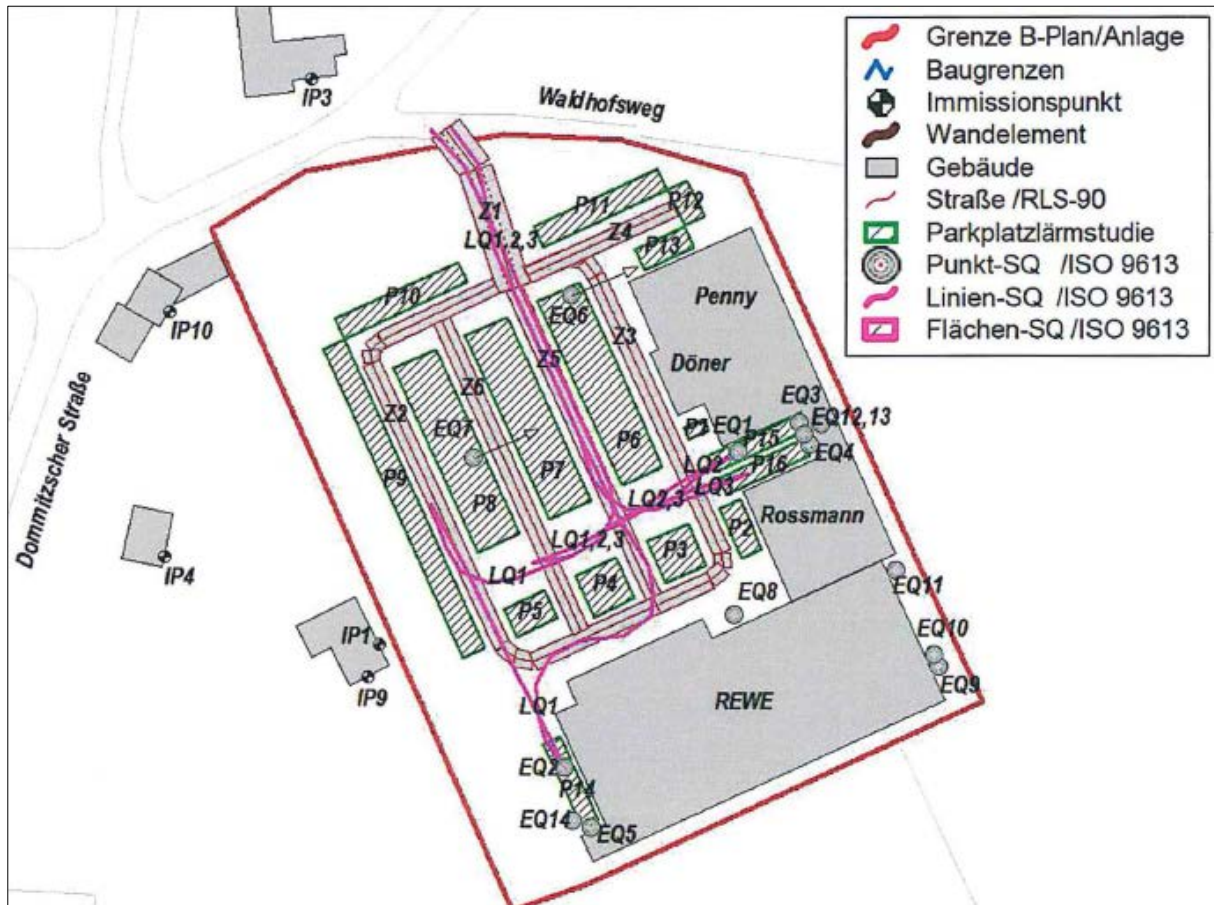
Lageplan Schallquellen Gesamtanlage und nächstgelegene Immissionsorte, Ausgangs-Variante (Planbetrieb Gesamt-Anlage)
